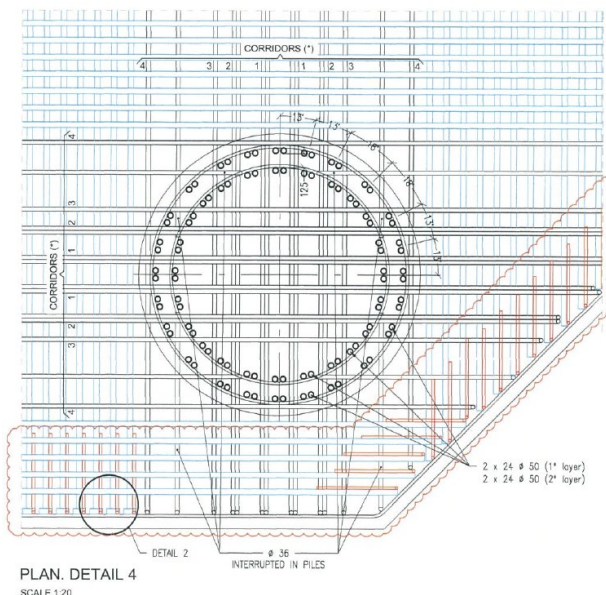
Esquema de armado de pilote tipo máximo y detalle de encuentro con el armado del encepado.
